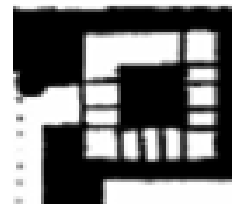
plan du minaret de la mosquée Awlad Al-Imam
